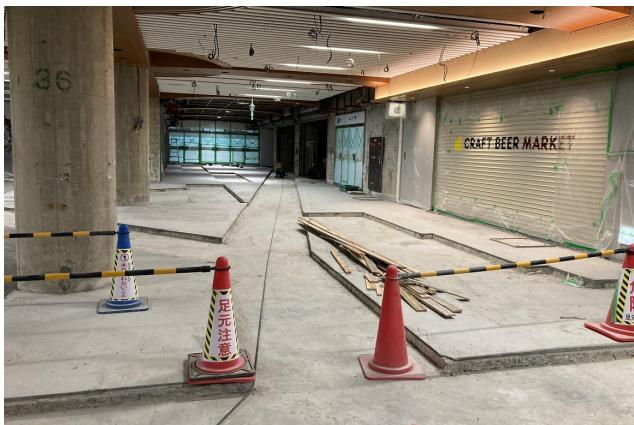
既設舗装の撤去後 (凹みは石工事範囲)
